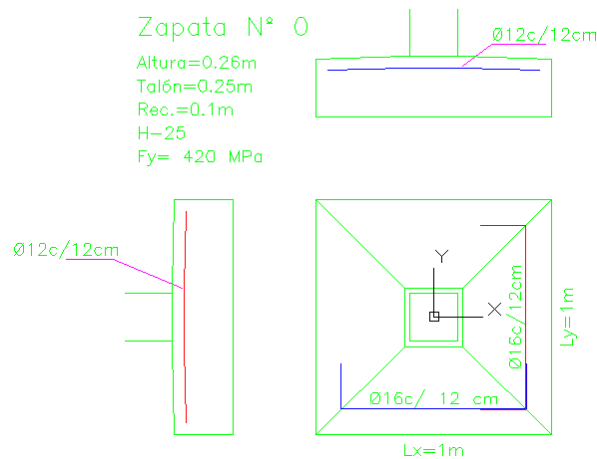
Ejemplo zapata con armadura superior, opción Plantas y Cortes. Fuente: elaboración propia
